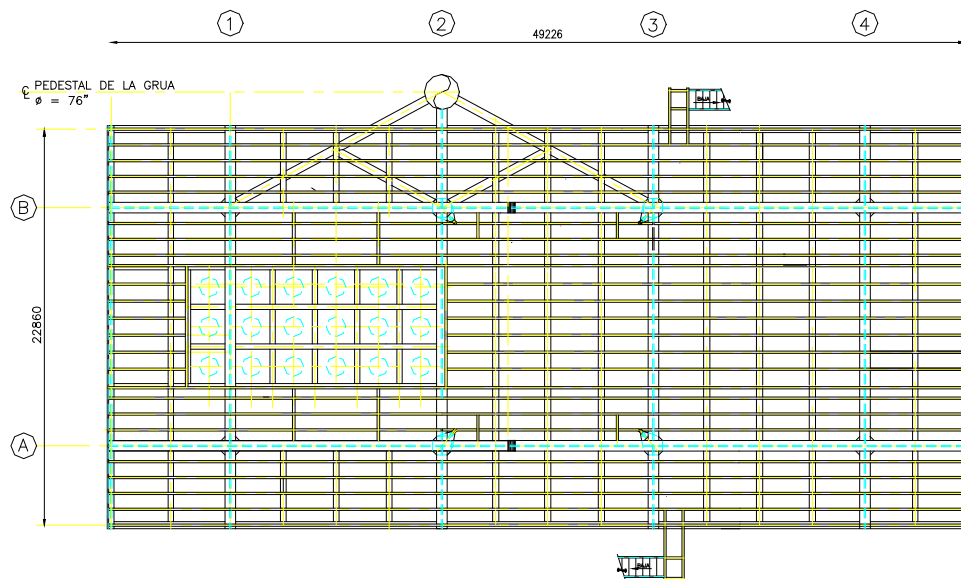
Planta estructural de la cubierta en uno o más niveles de la Superestructura.
